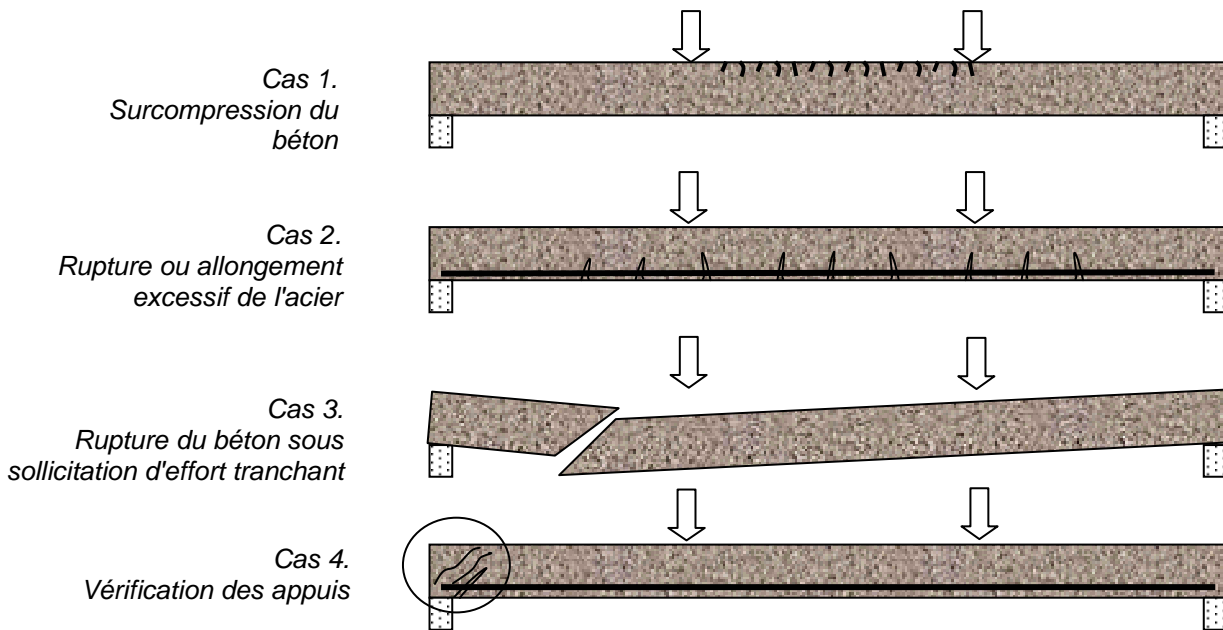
Modes de rupture d'une poutre sur 2 appuis sollicitée en flexion
